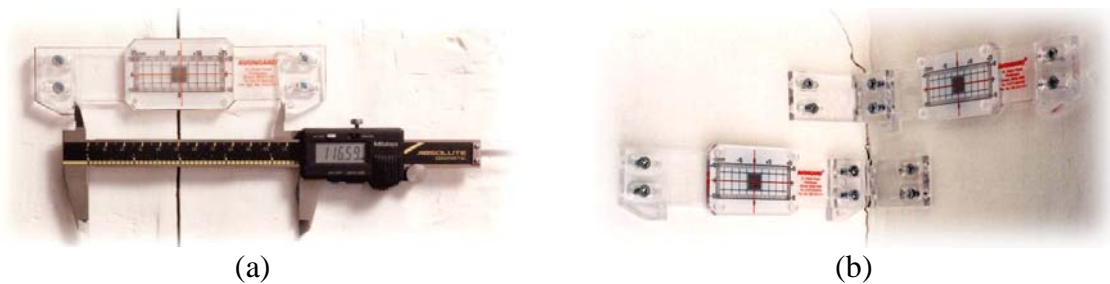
Exemplo de um fissurómetro: (a) fissurómetro de um eixo; (b) fissurómetro de canto (www.avongard.com)
